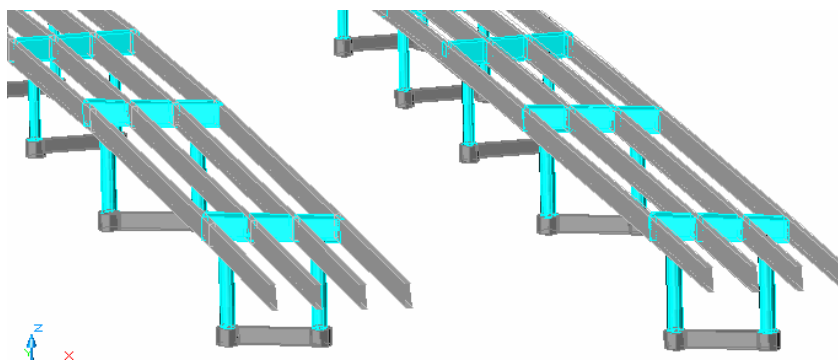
VIGAS PRINCIPALES 8 UNIDADES.
